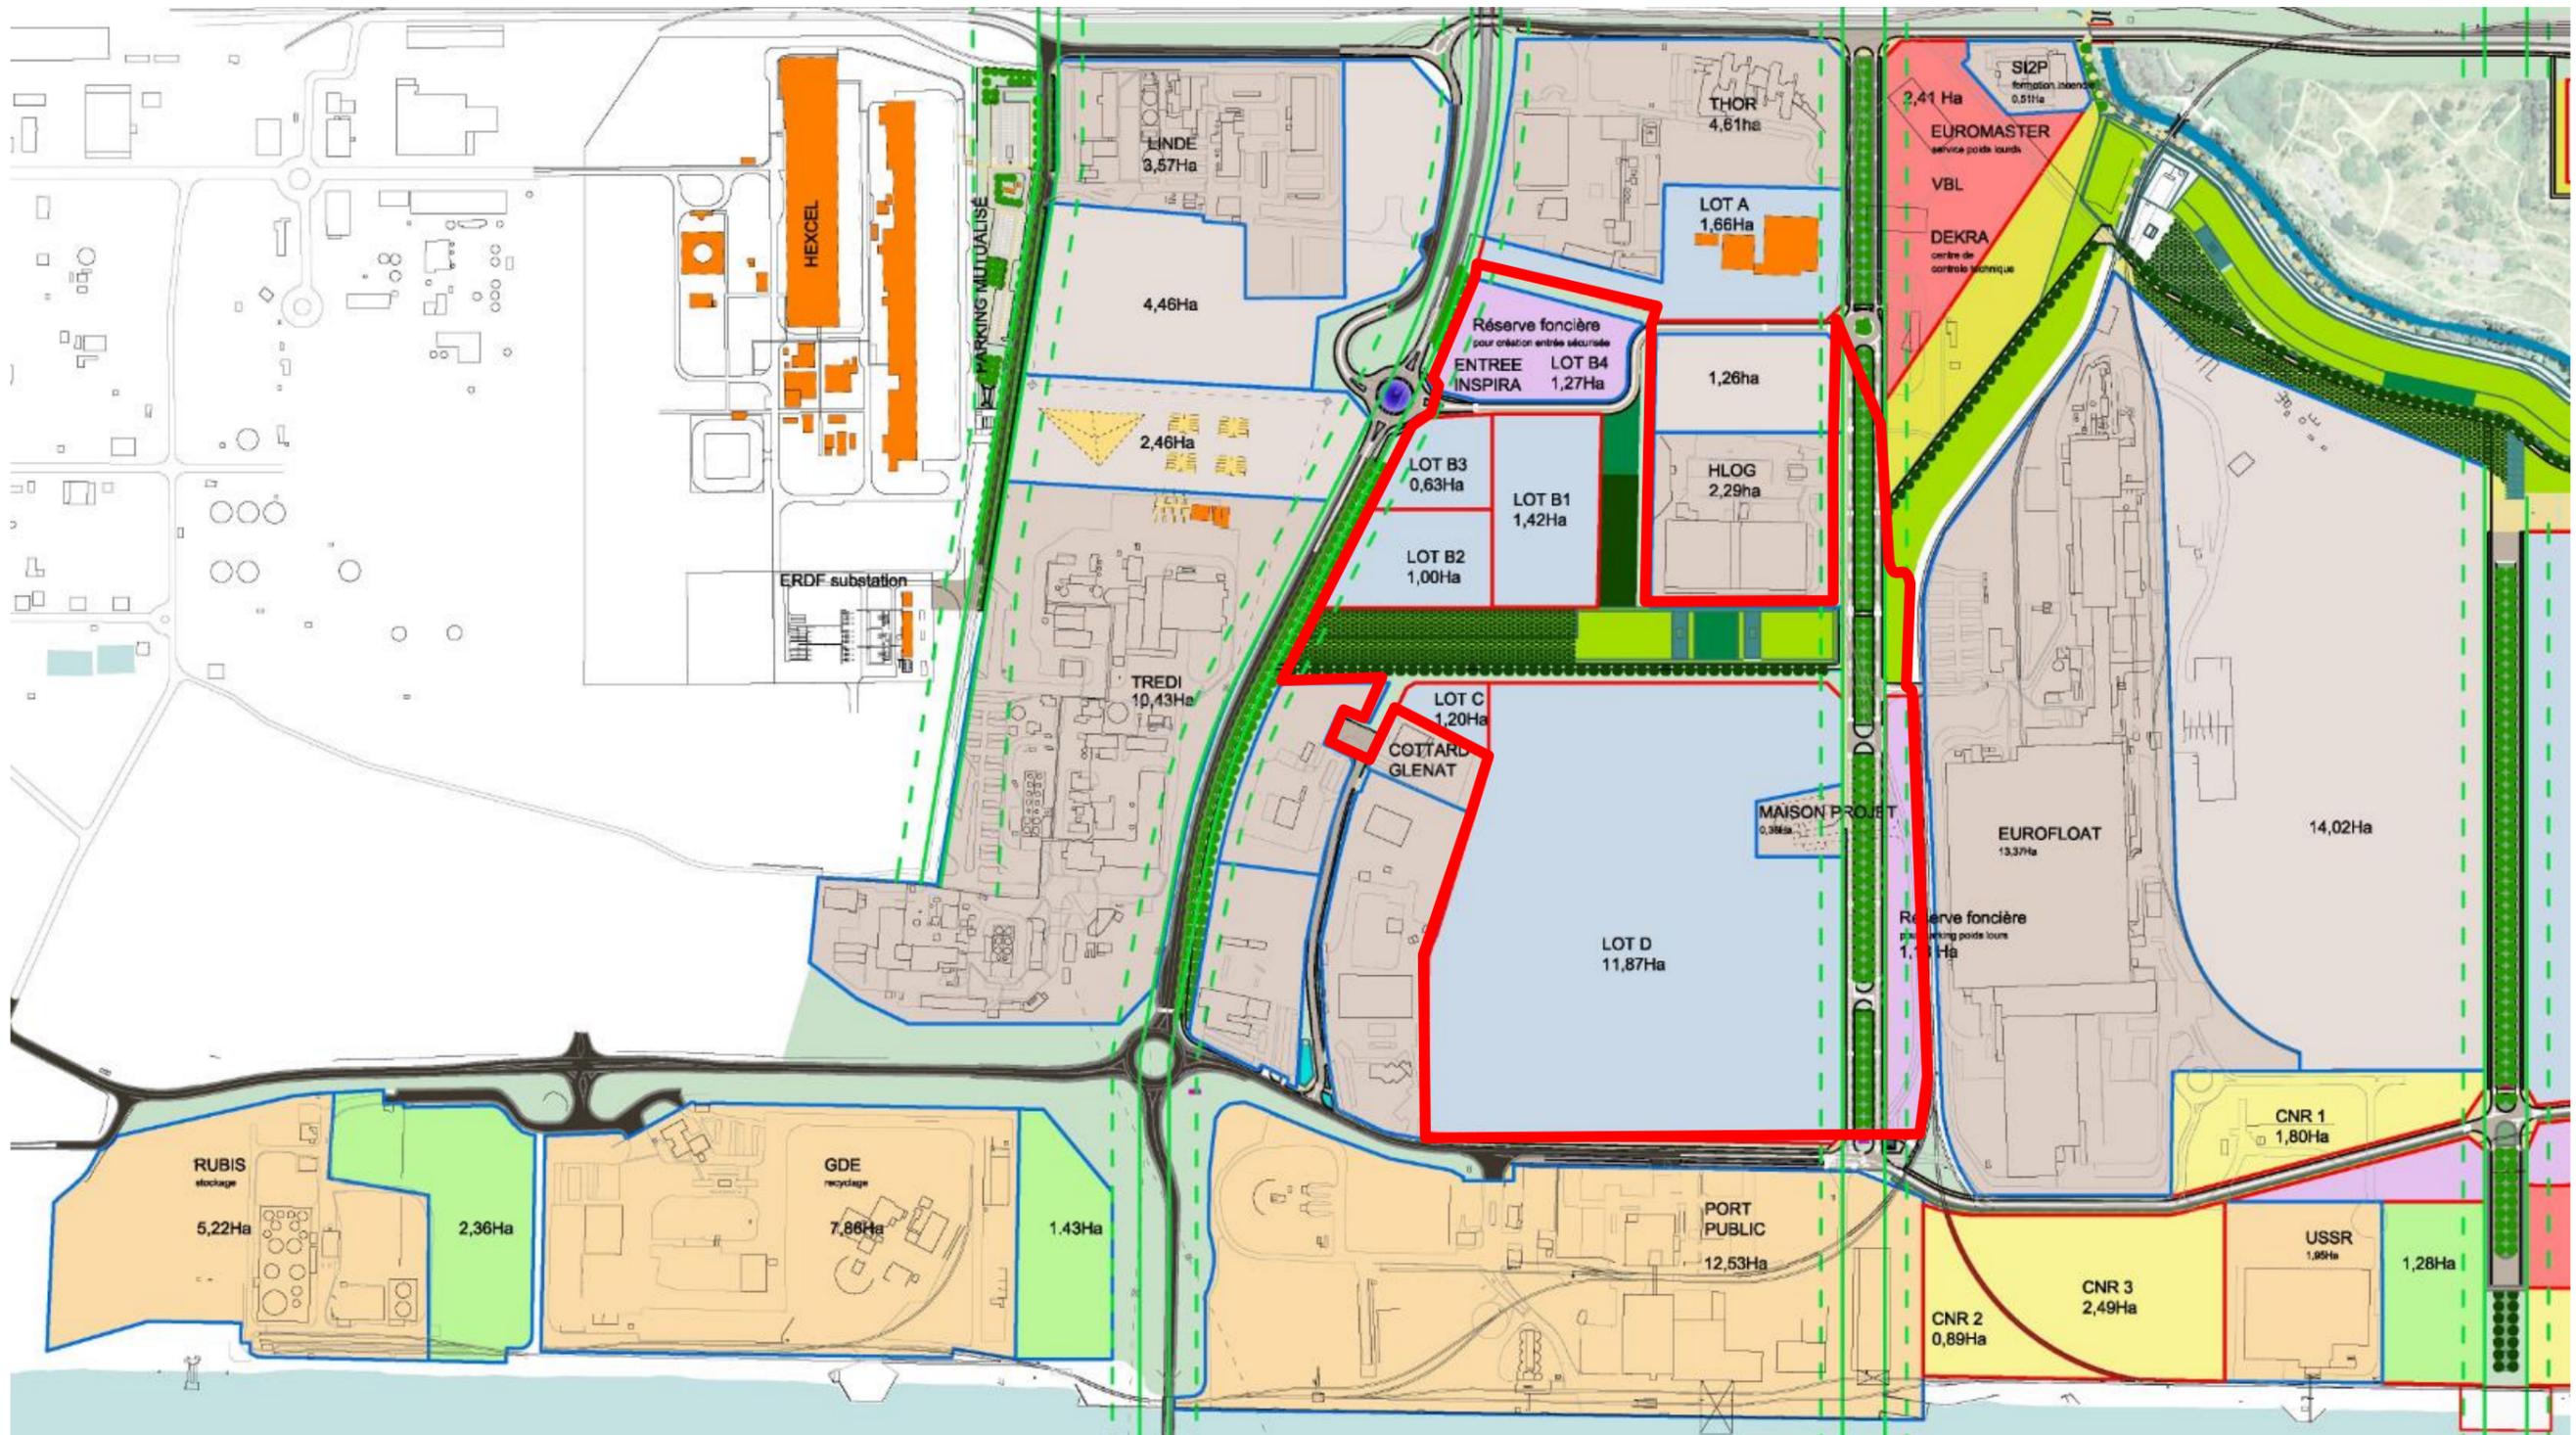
Plan masse du projet avec distinction des lots au droit du secteur Nord
